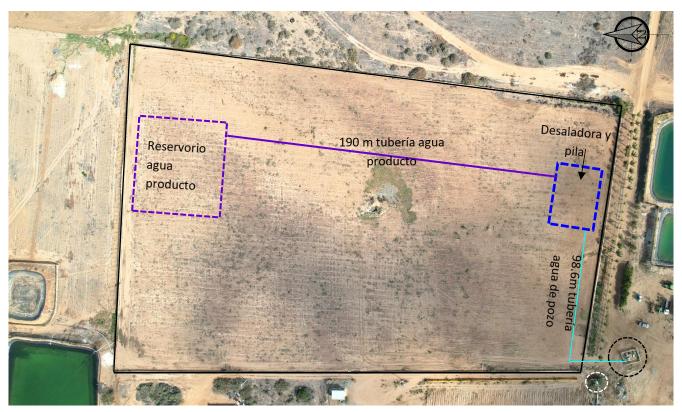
Vista aérea del predio (polígono negro) donde se construirán la planta desaladora y obras complementarias. El circulo blanco punteado marca la subestación electrica y el circulo negro punteado el pozo.
